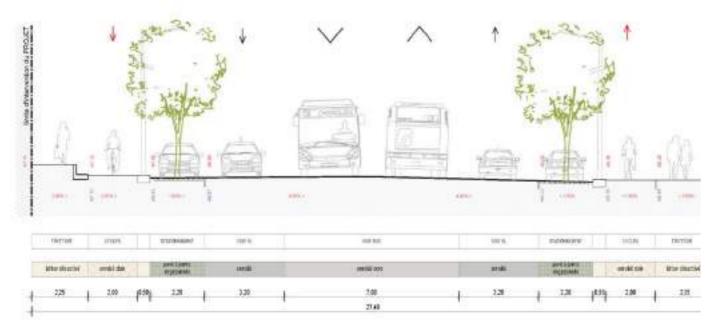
Profil futur de l'Avenue Bollée - Sud
